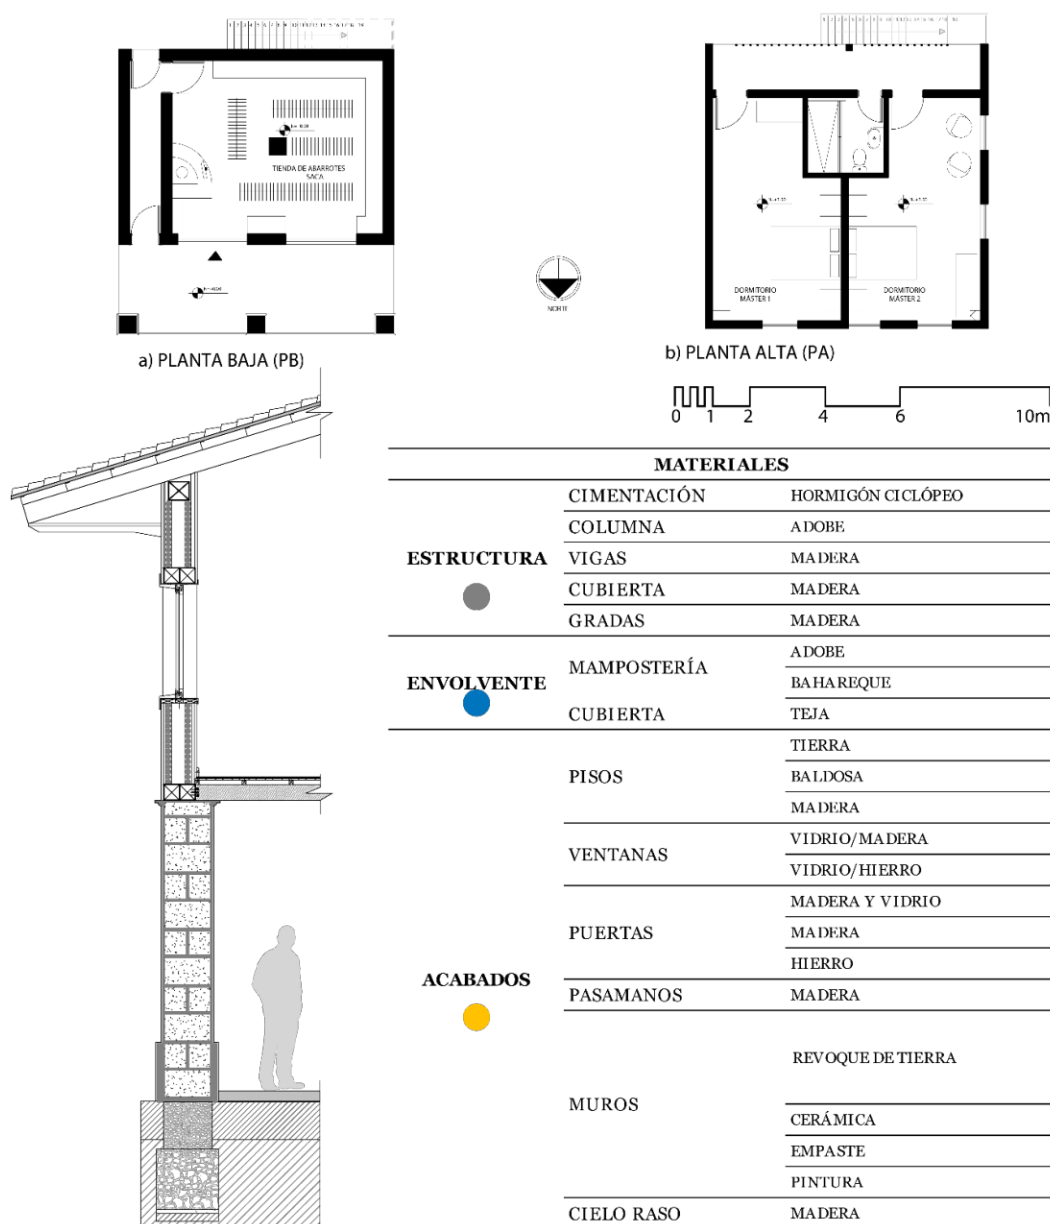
a) Planos de planta baja. b) Planos de planta alta. c) Sección constructiva. Fuente: Elaboración propia.
